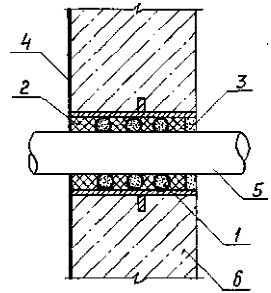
Пропуск трубопровода через гидроизоляцию с набивным сальником:
